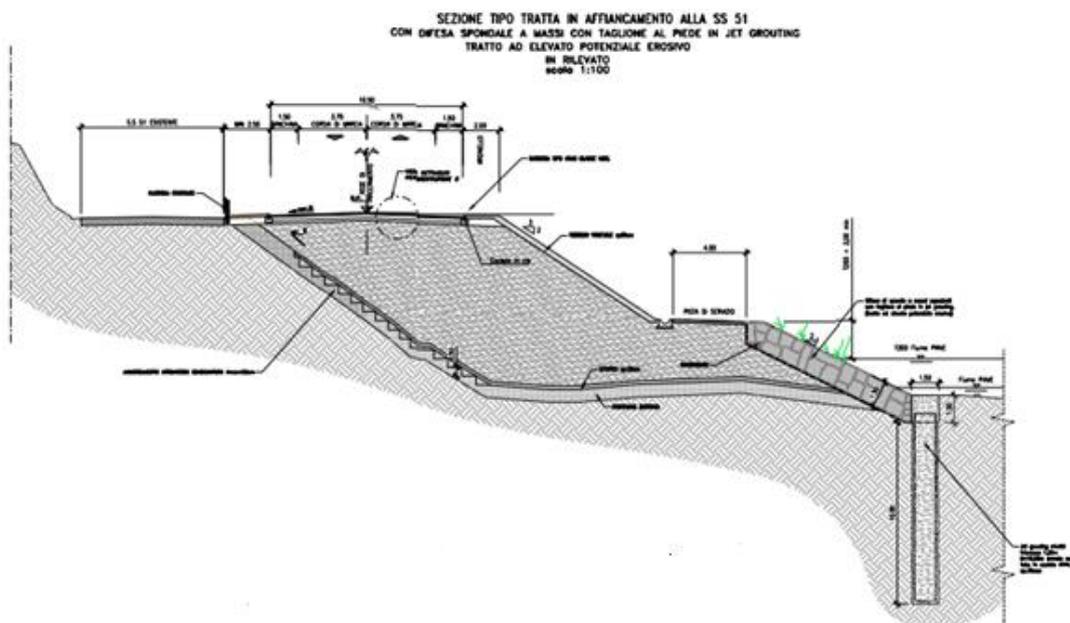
Sezione con protezione di sponda con massi ciclopici e piede con jet grouting
